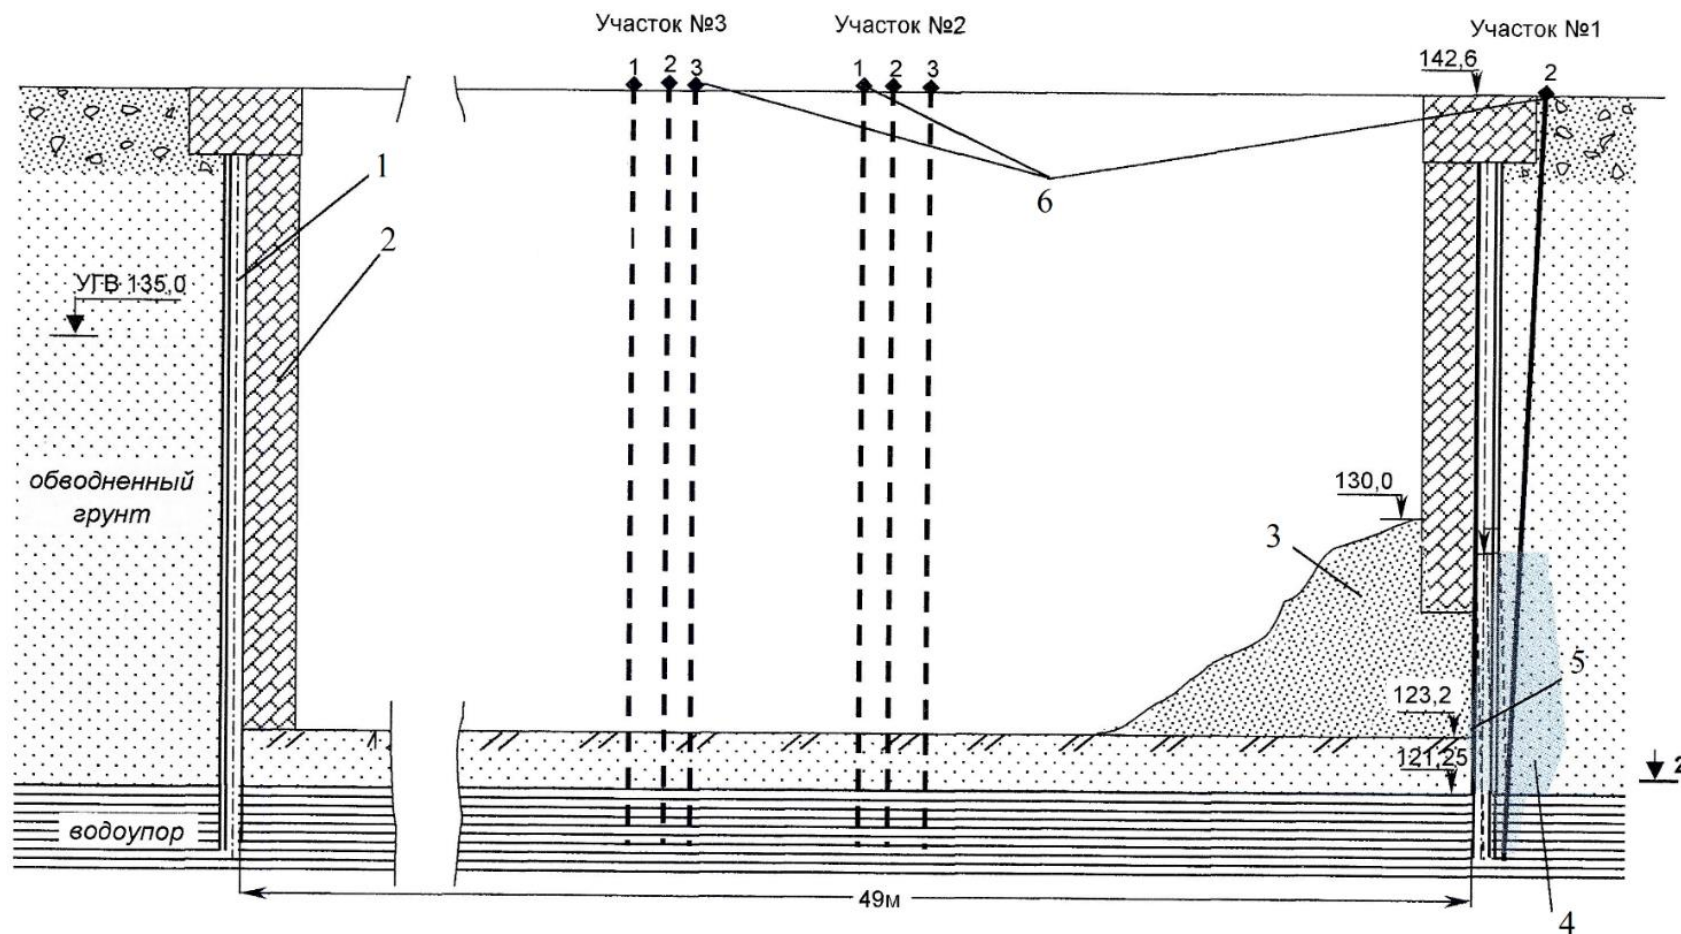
Замораживание грунтов при строительстве Лефортовского тоннеля в г. Москве. Разрез монтажной камеры [45]: 1 – шпунтовое ограждение; 2 – железобетонная стена монтажной камеры; 3 – грунтовый пригруз; 4 – зона замораживаемых грунтов; 5 – место прорыва воды в котлован; 6 – замораживающие колонки
